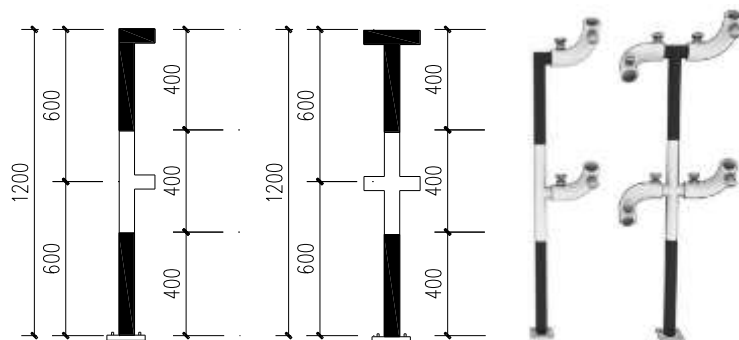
F 型、干型防护栏示意图（单位：mm）
